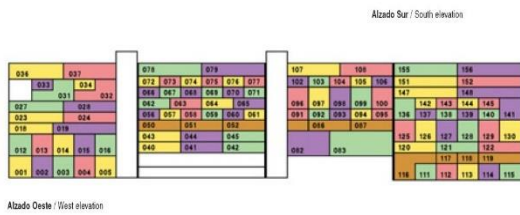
Alzado sur con tipologías. (ElCroquis, 2016)
